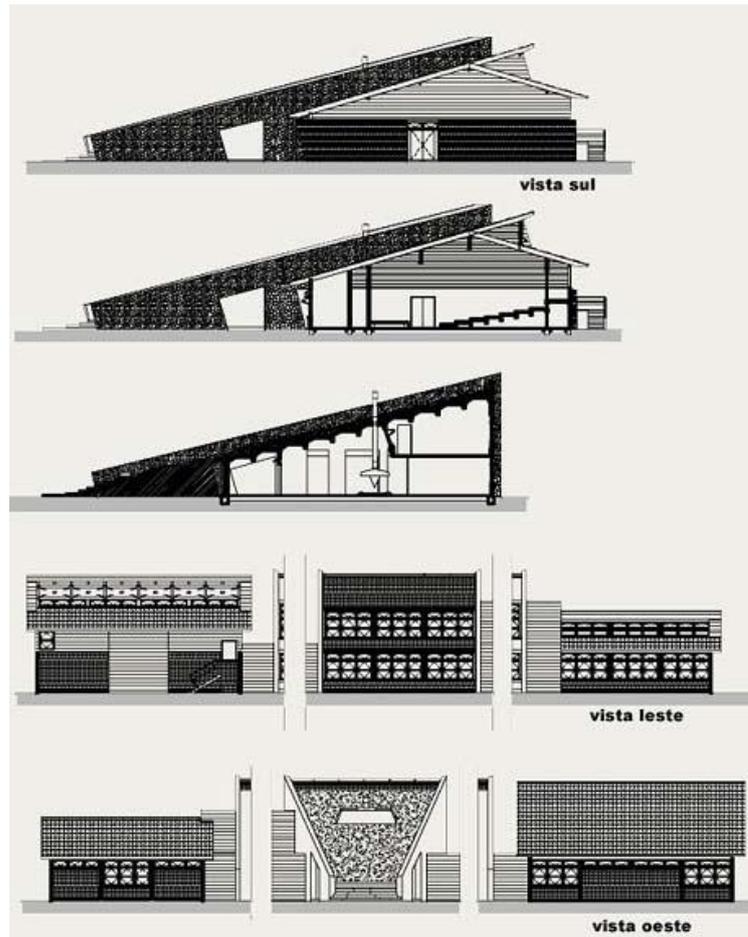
Cortes e vistas do Centro de Recepção
